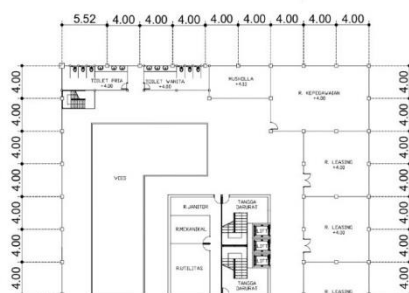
Denah Lantai 2 Electric Vehicle Center
